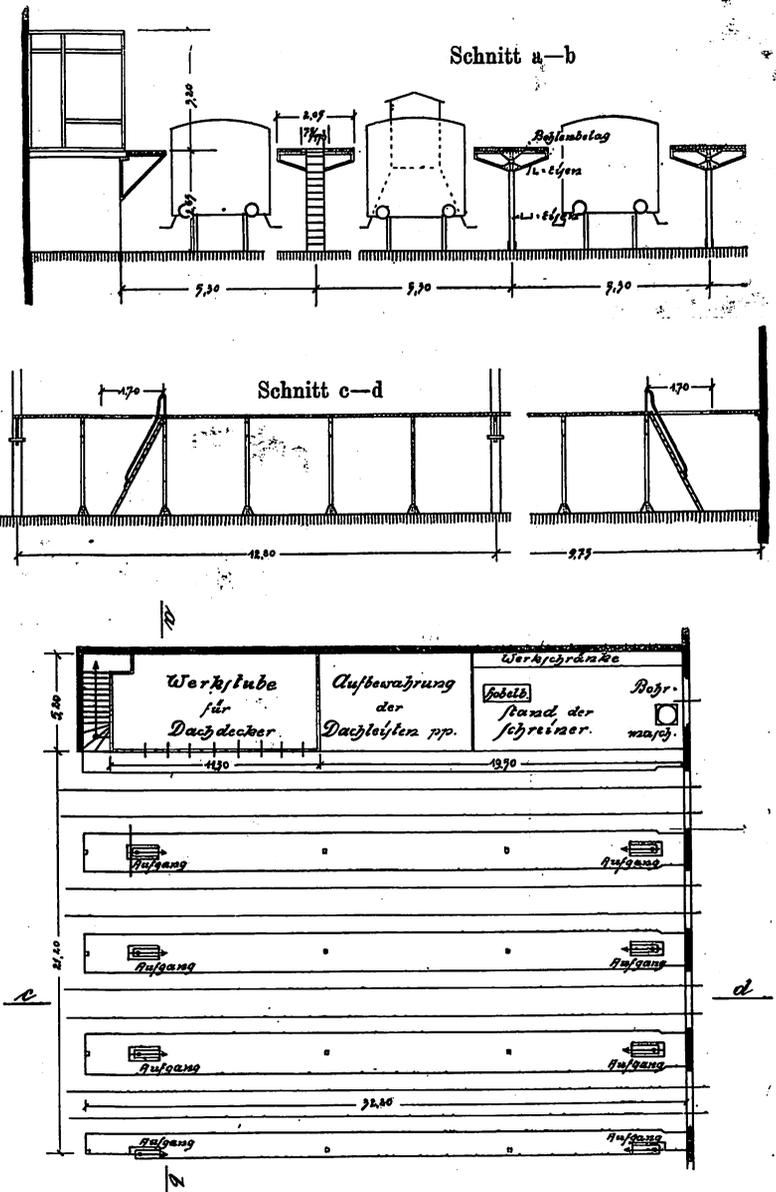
Grundrifs und Querschnitte der Dachausbesserungswerkstätte.
